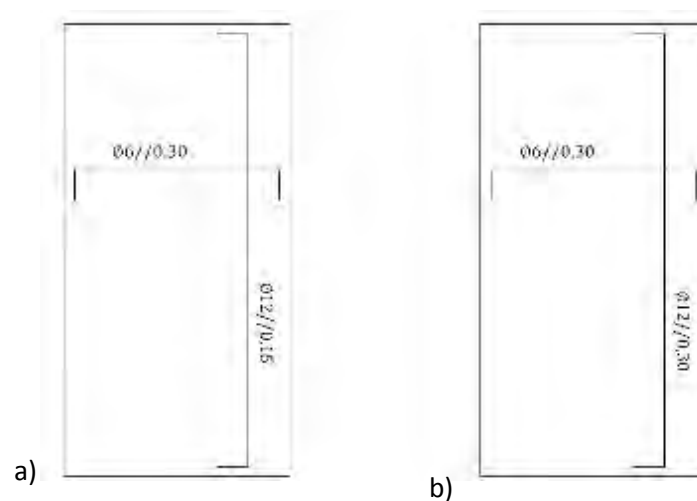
Disposição da armadura na parede resistente: a) na face interior; b) na face exterior
